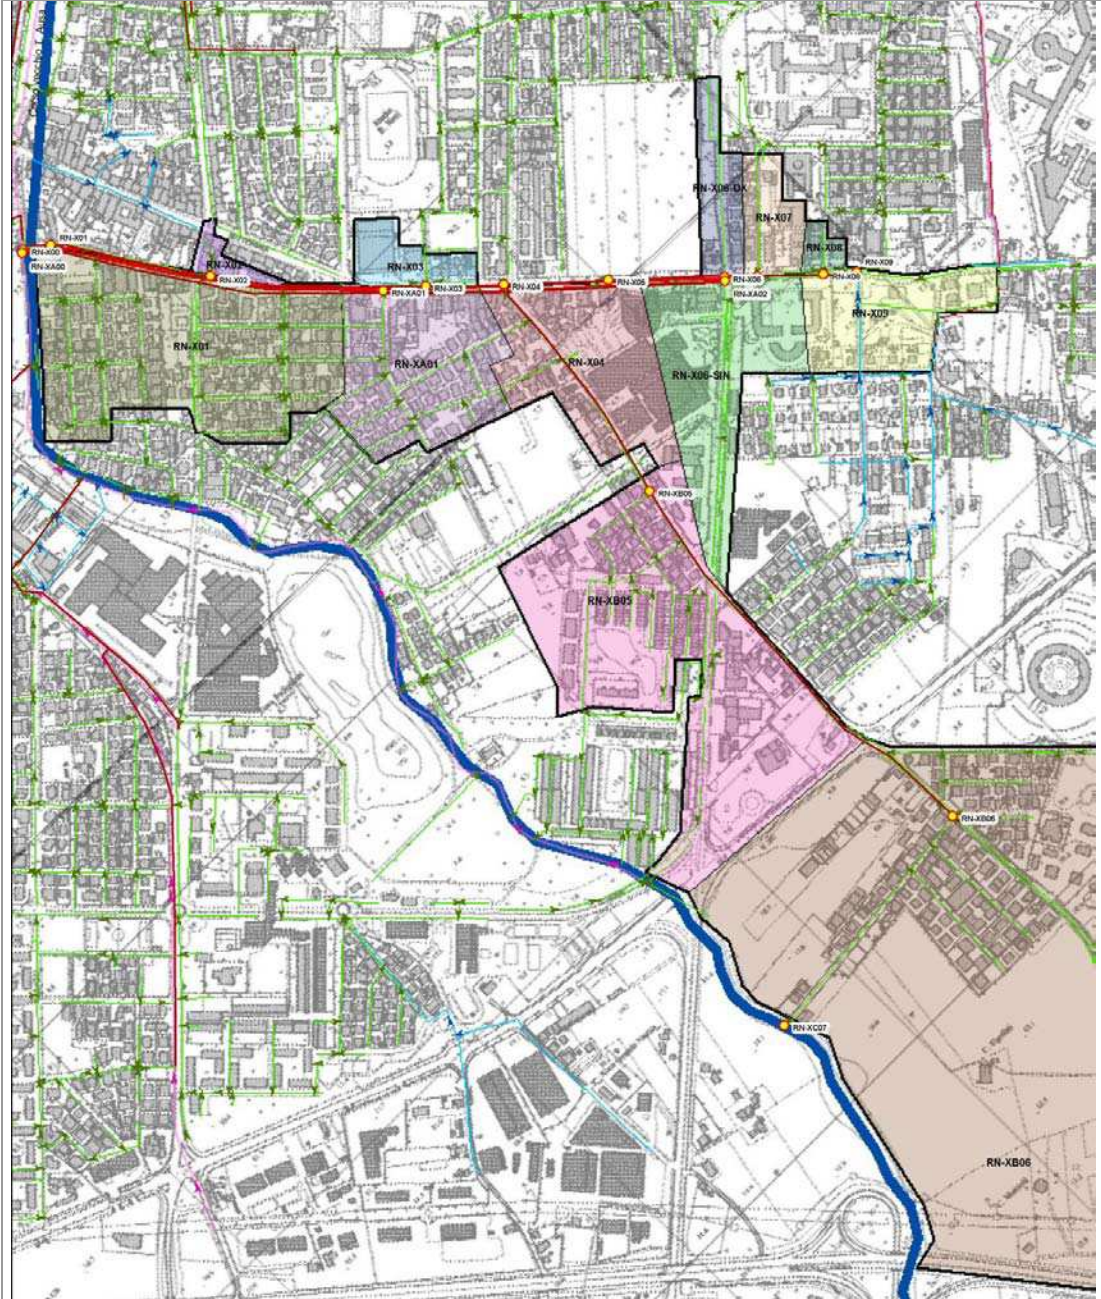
Planimetria del bacino ex fossa Barattona
